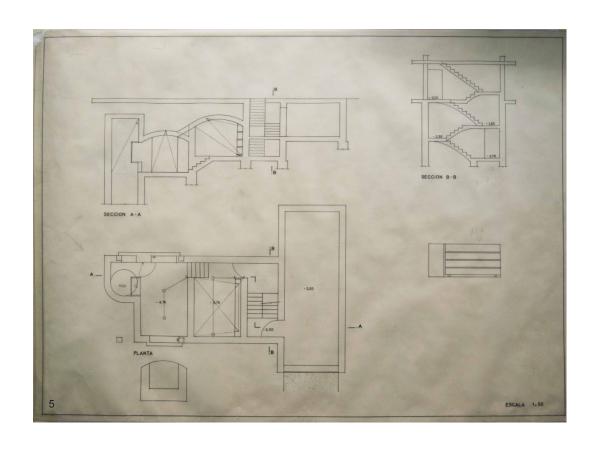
Planta baja. Ejecución. Marzo 1959. (FADLS)
